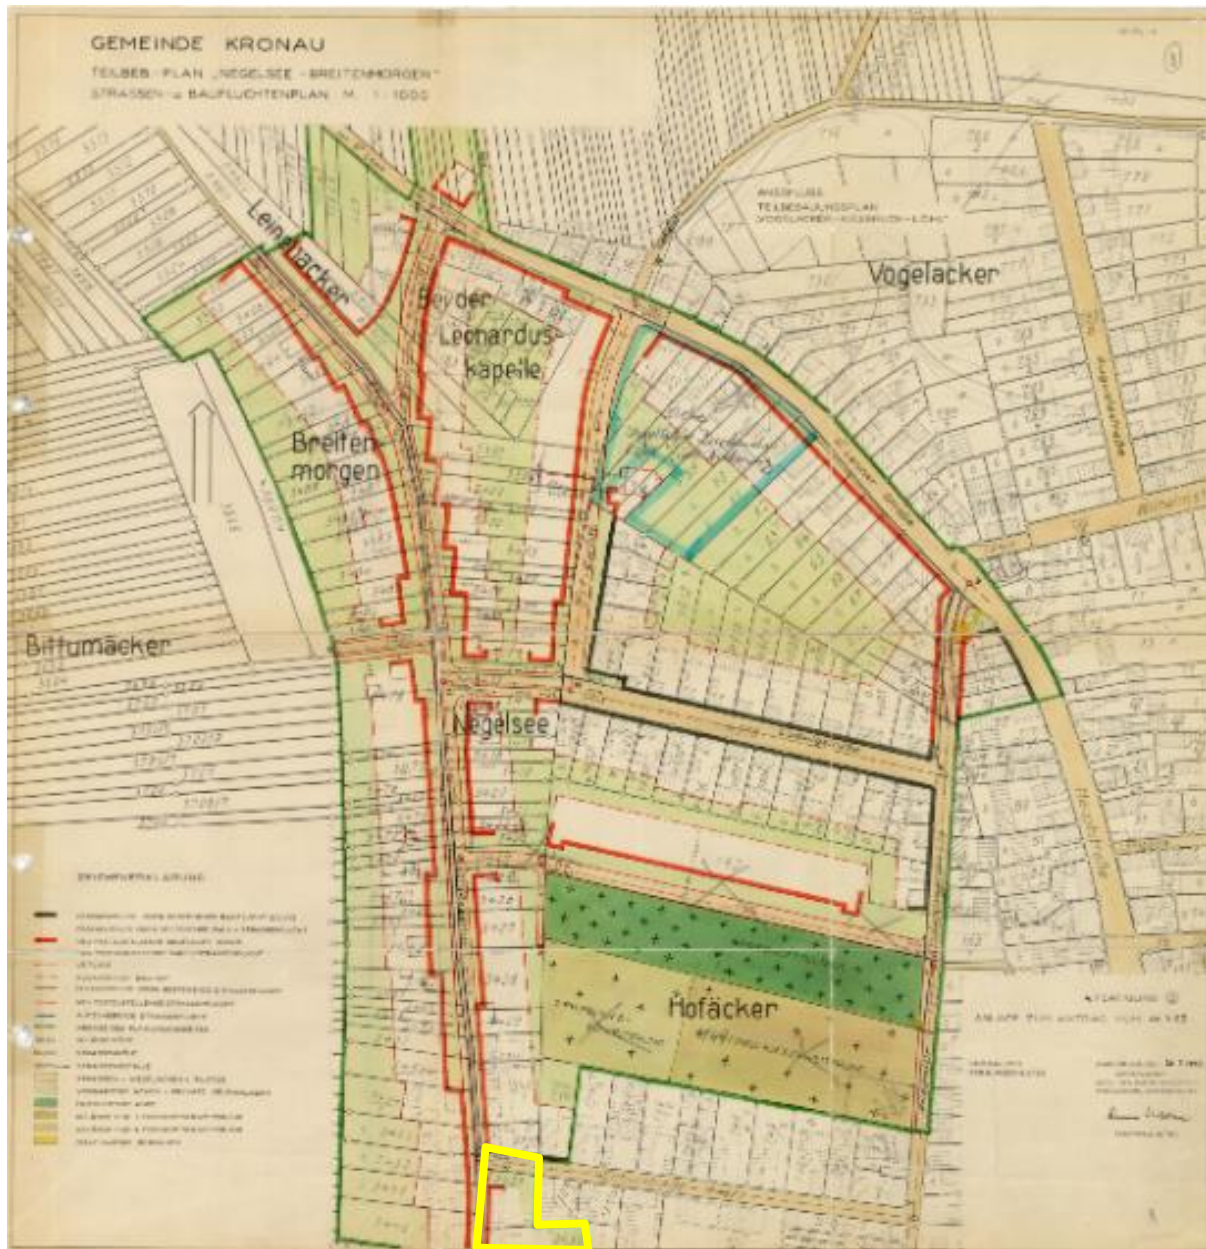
Planteil des Bebauungsplans „Negelsee-Breitenmorgen“.
